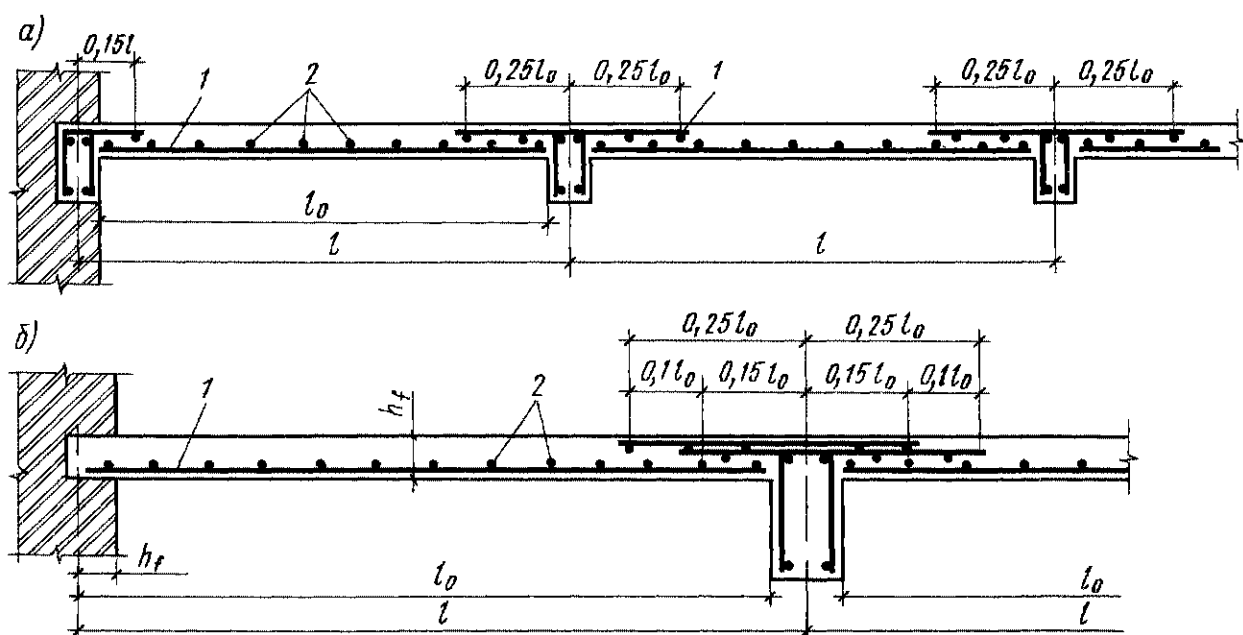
Армирование плиты плоскими сварными сетками
